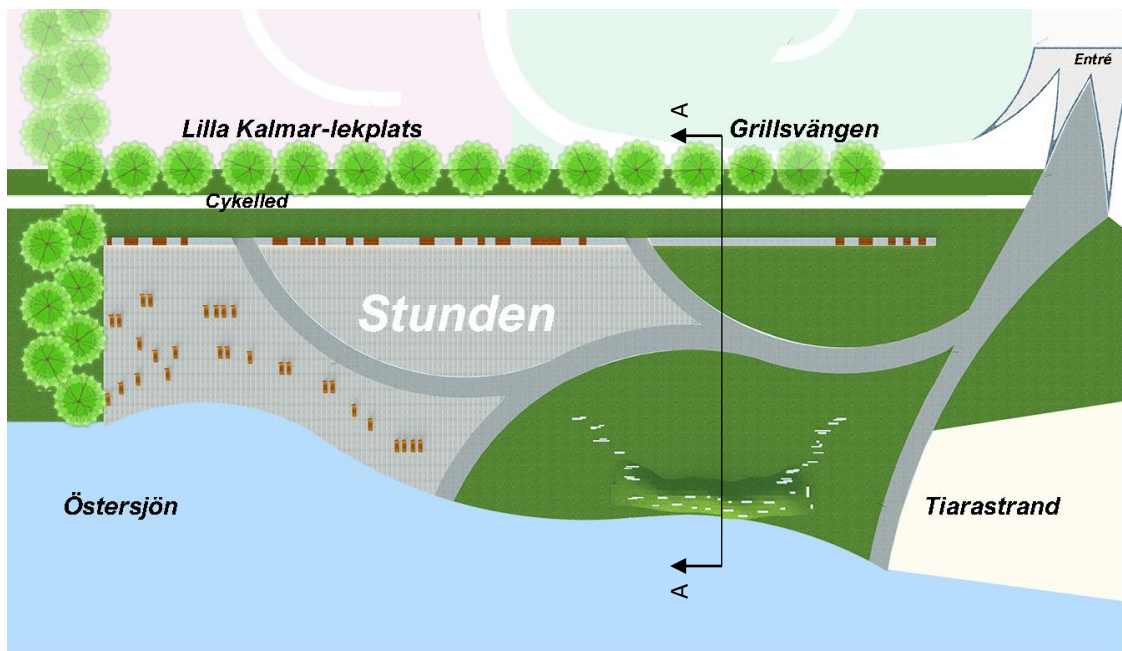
Planvy över Stunden och parkens backe i skala 1:1500
